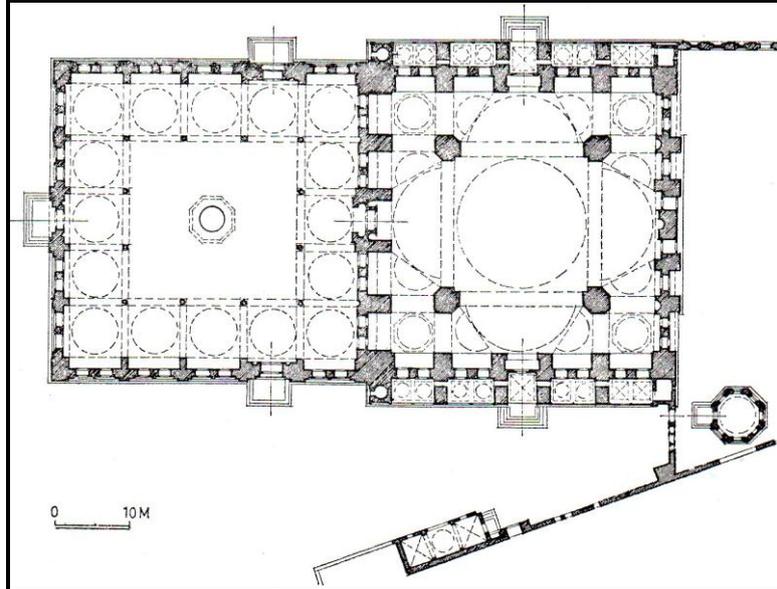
المسقط الأفقي لمسجد بايزيد الأول - استانبول
